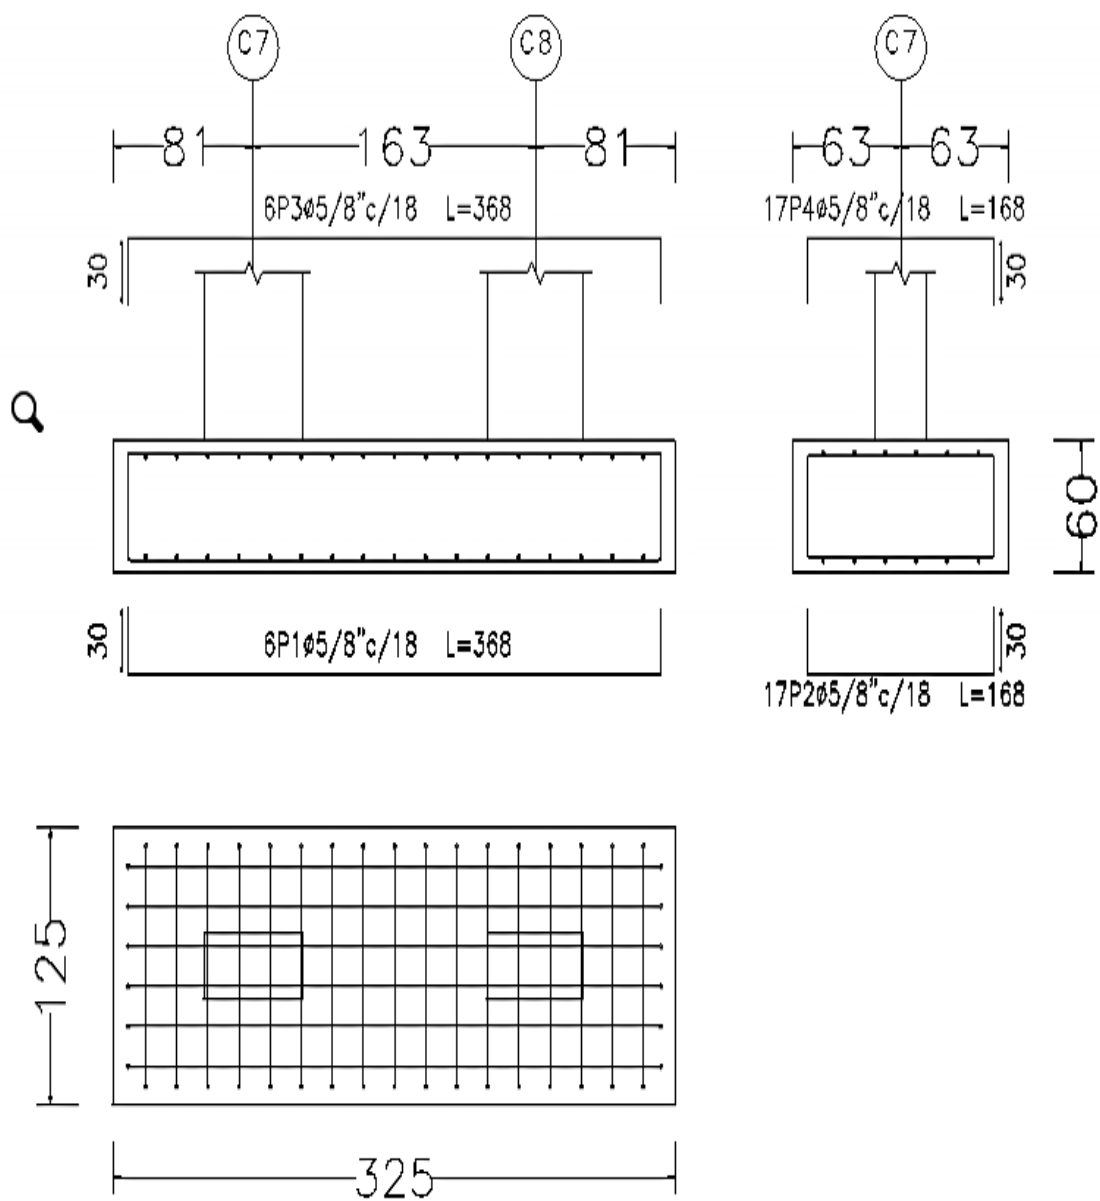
Detalle estructural de zapata corrida C7 – C8.
